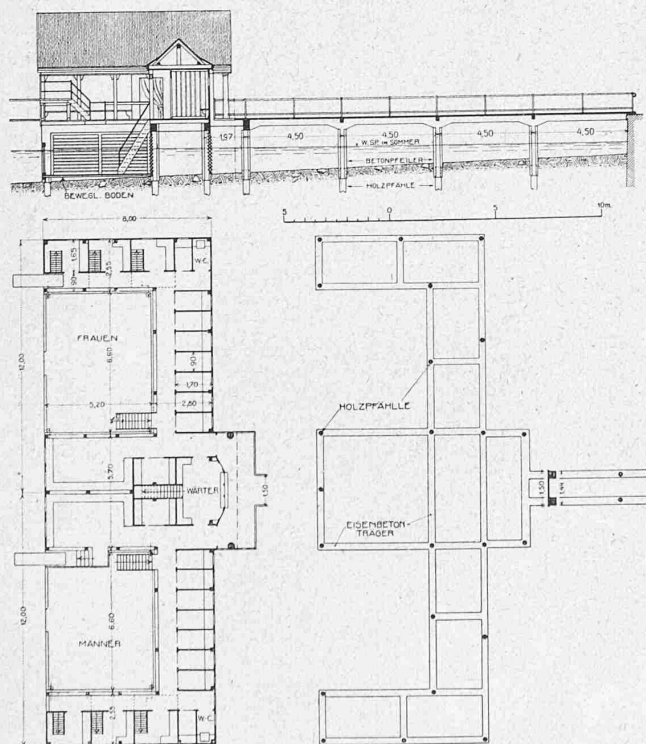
bis 3. Schnitt und Grundrisse zur Badanstalt Oberrieden. — 1:300.
